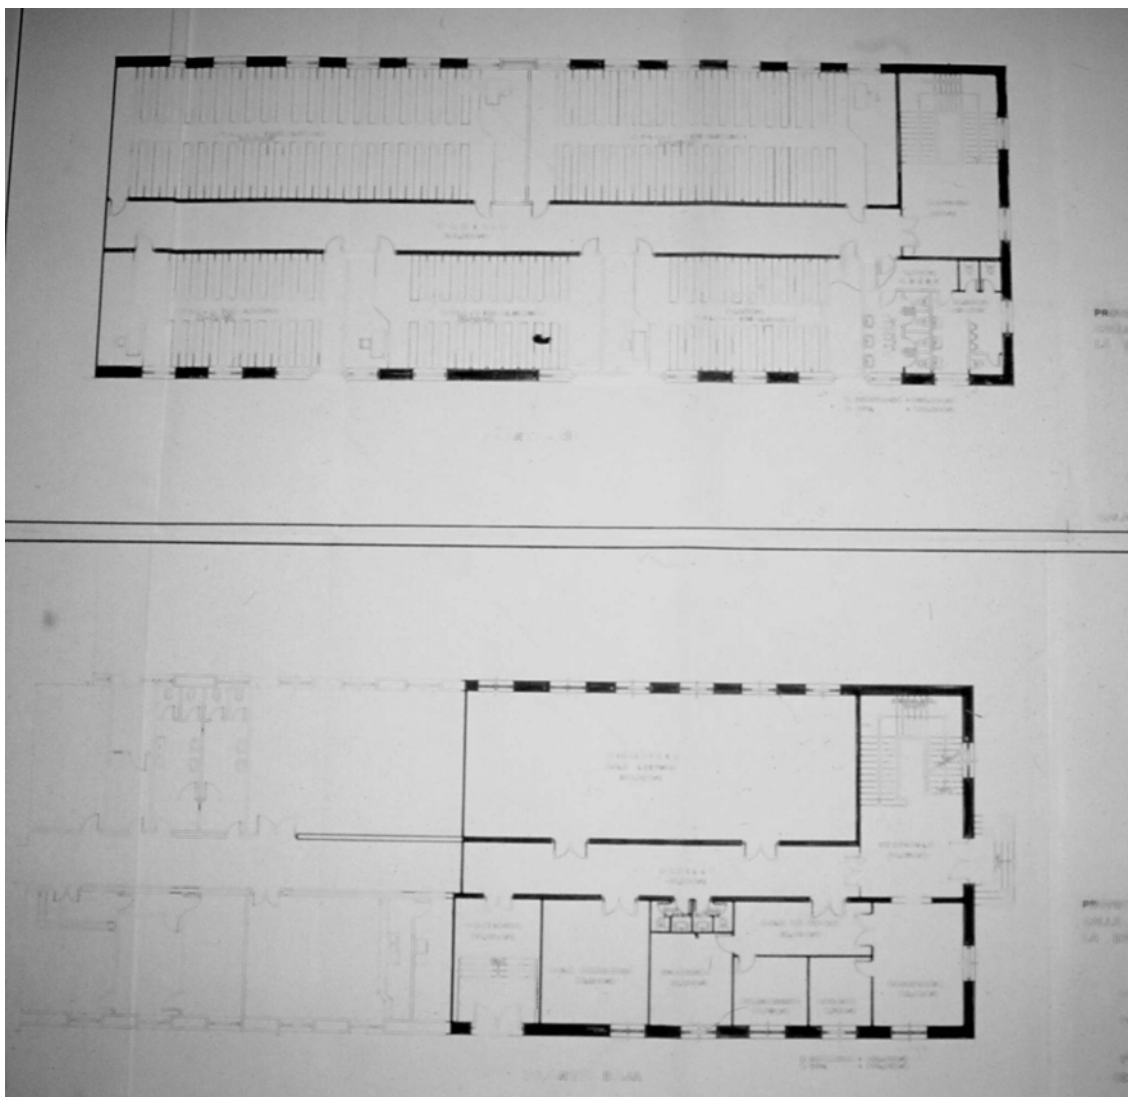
Pabellón de aulas. Planta baja y primera, por J. Gómez Riesco, junio de 1987.
